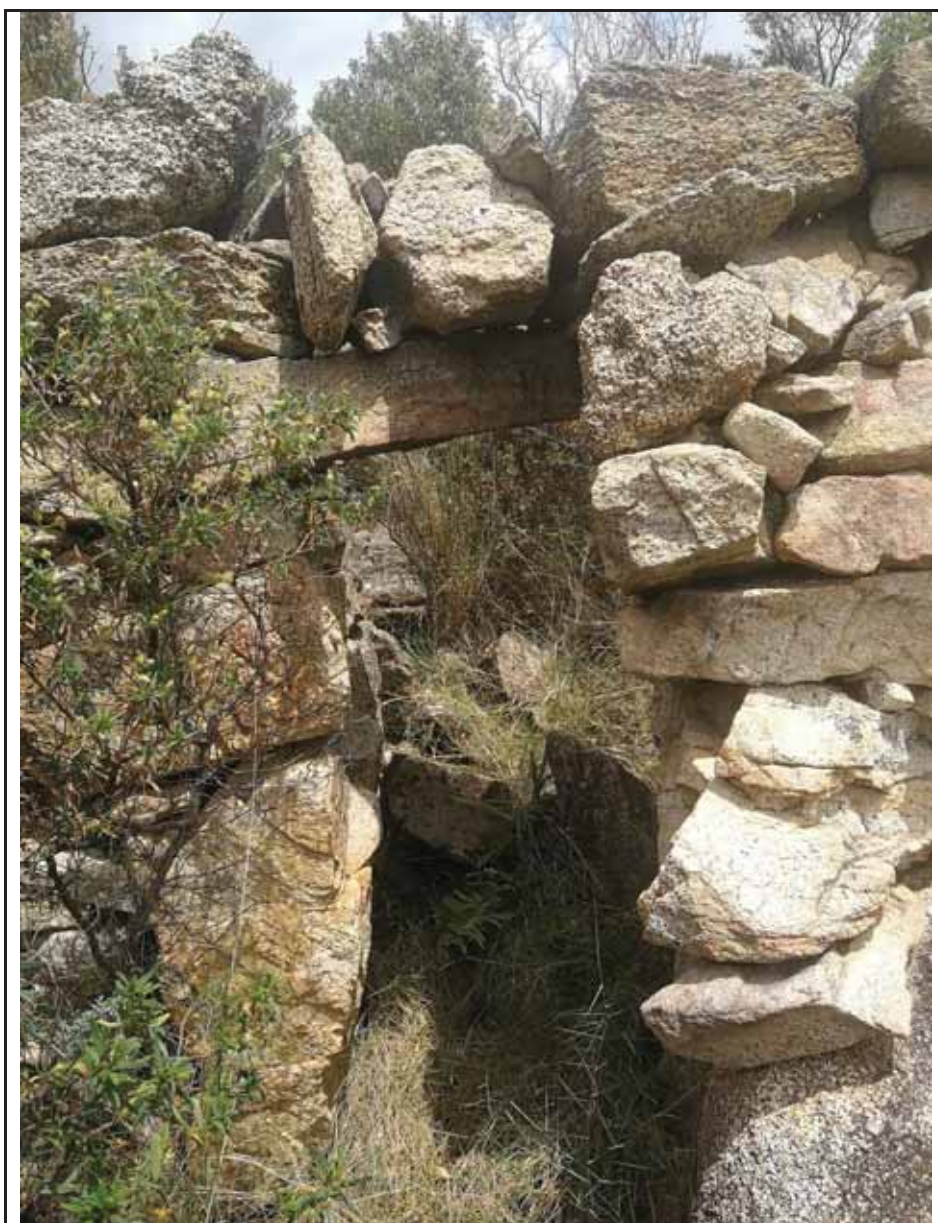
ED 4, construcció de pedra seca. Detall de l'obertura d'accés.
